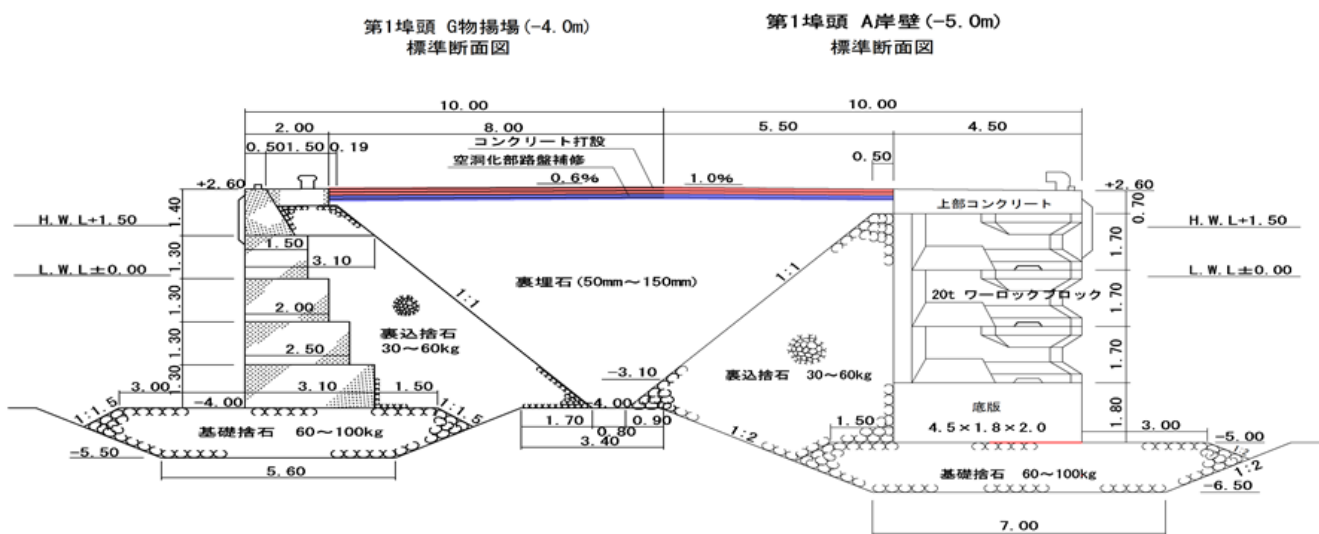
No.28 大洗港区\_第1埠頭地区 A岸壁の断面図 (復旧後)
